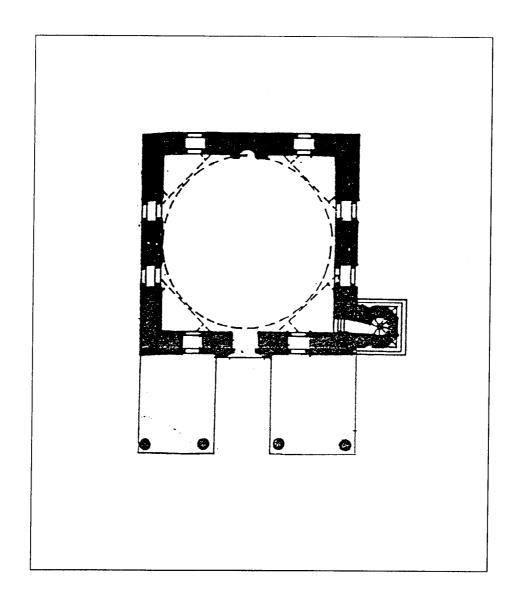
مسقط أفقي لمسجد خداوندكار في بهرام قلعة (عن : كوران) .
